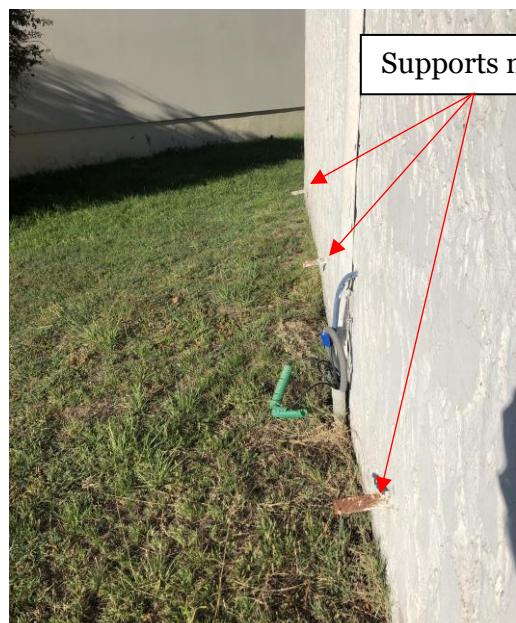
Photo des supports métalliques rouillés sur la façade Sud
